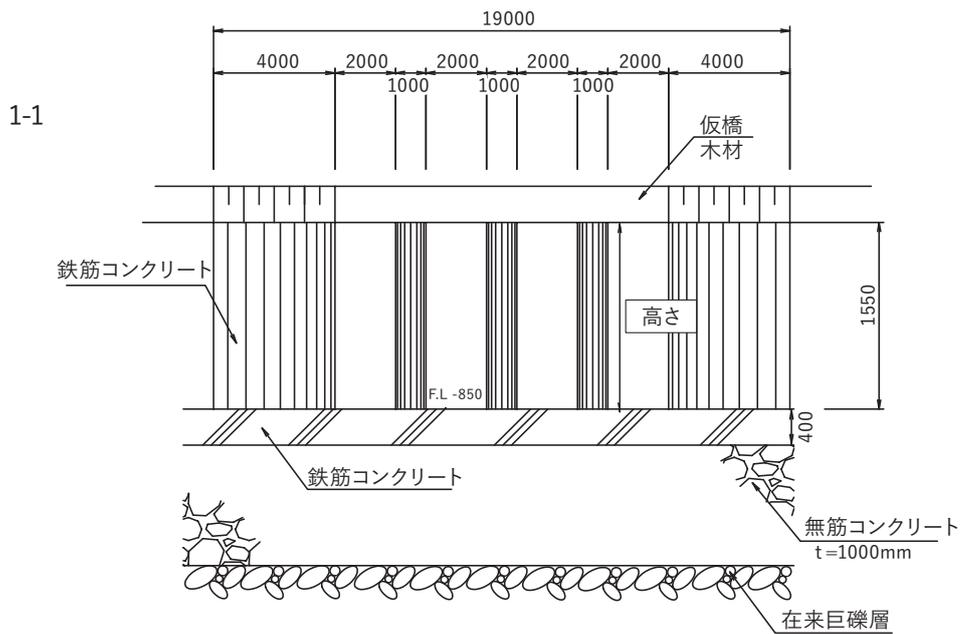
土砂吐きの横断面図例<sup>3)</sup>
